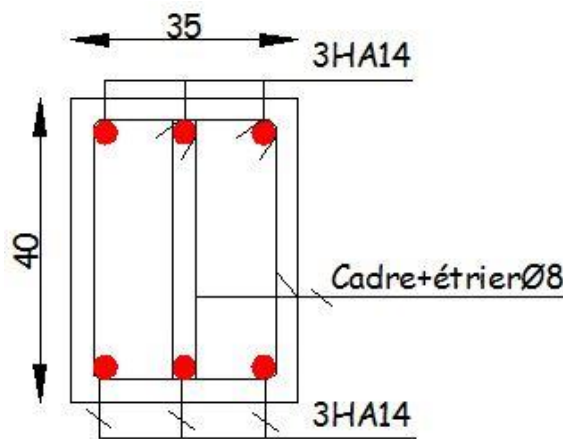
schéma de ferrailage de la poutre brisée en appui et en travée.
